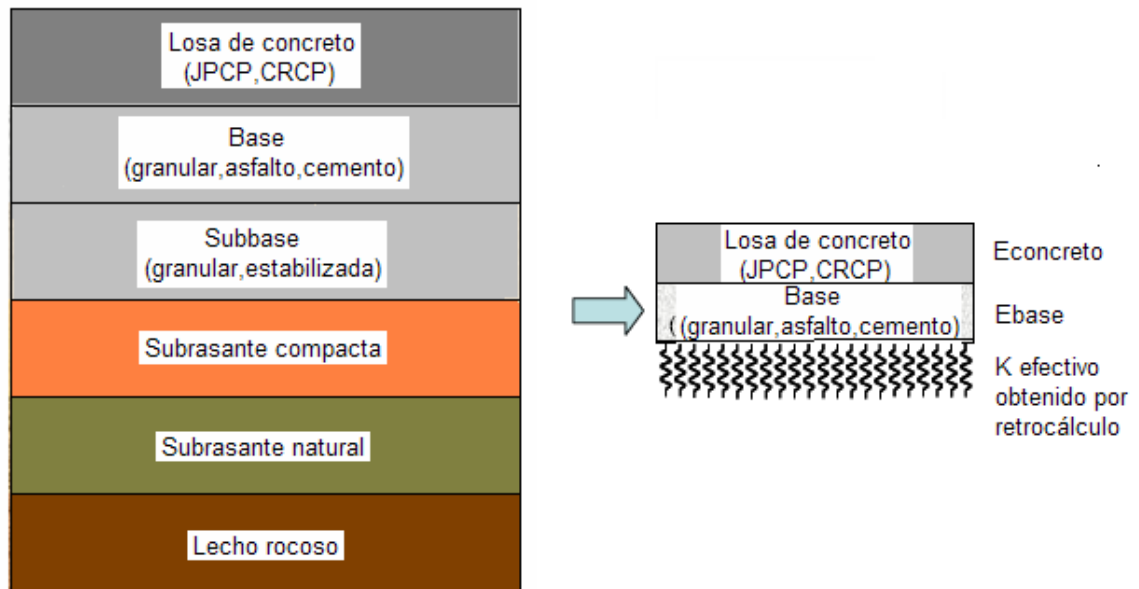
Modelo estructural para el cálculo de la respuesta estructural de un pavimento rígido
